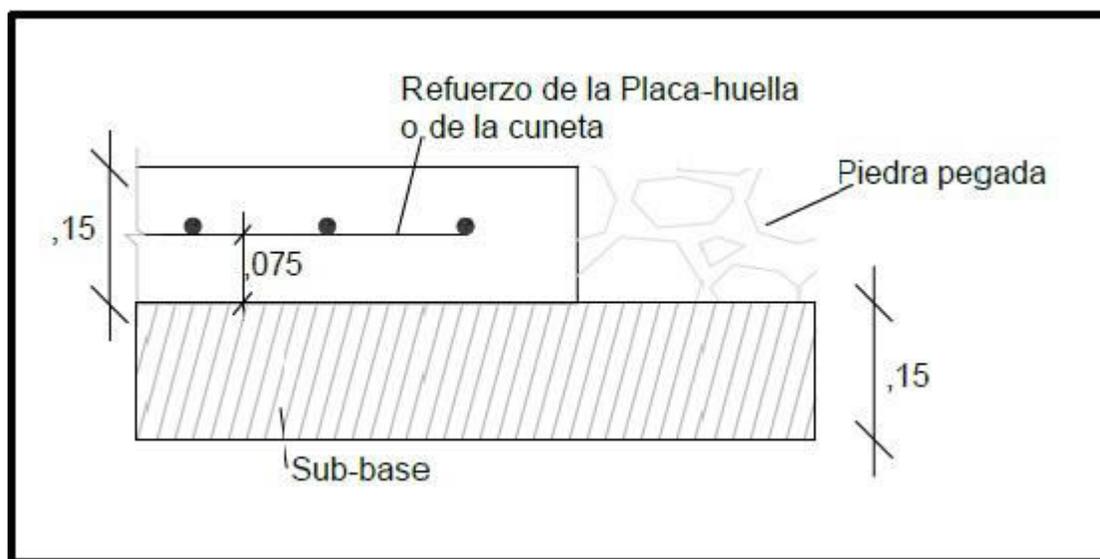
Junta longitudinal de la construcción entre Placa-huella, Riostra o Berma Cuneta y la Piedra Pegada.
